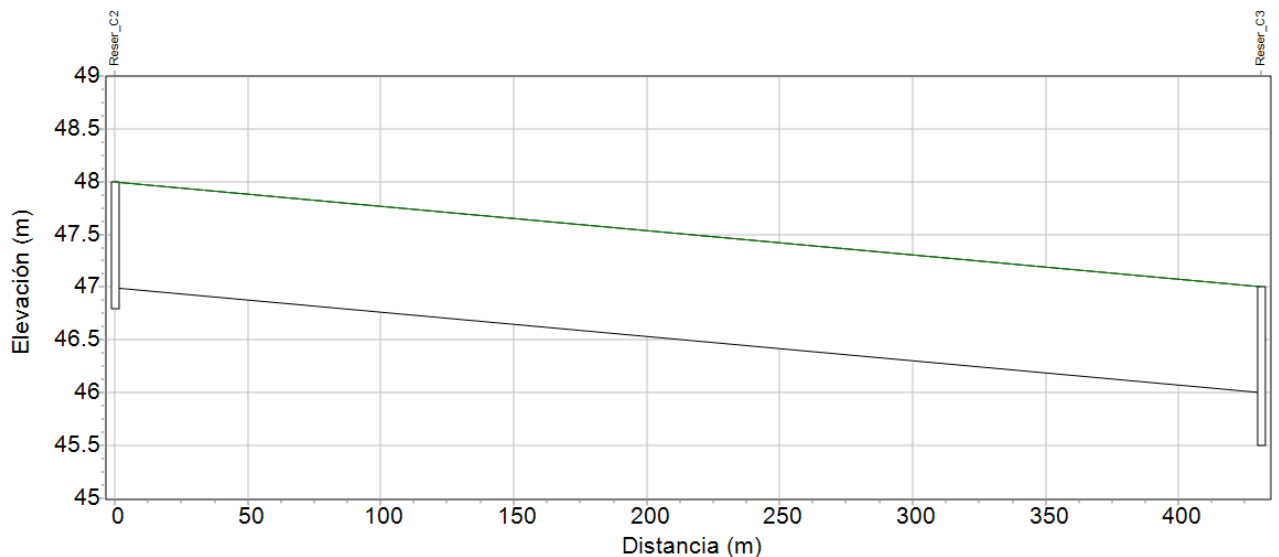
Perfil longitudinal – Canal. Fuente: SWMM
